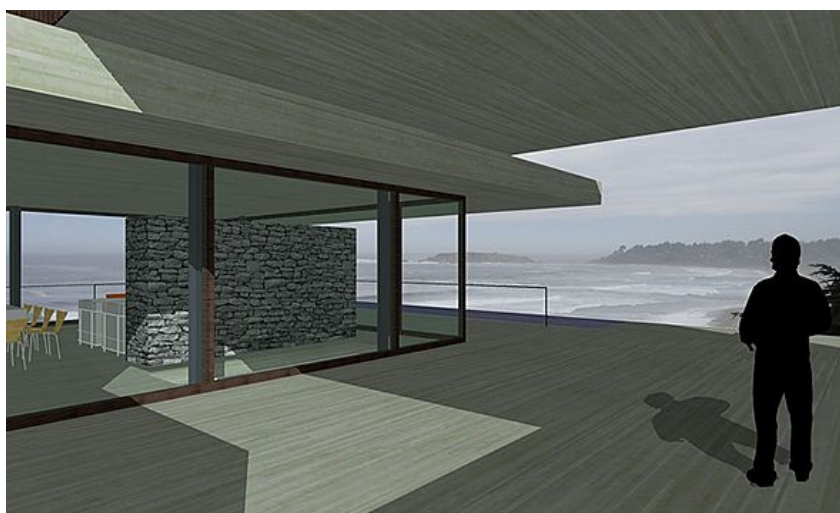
Vista da paisagem a partir do deck (CASA BRITAN E MASSAI, 2008).
